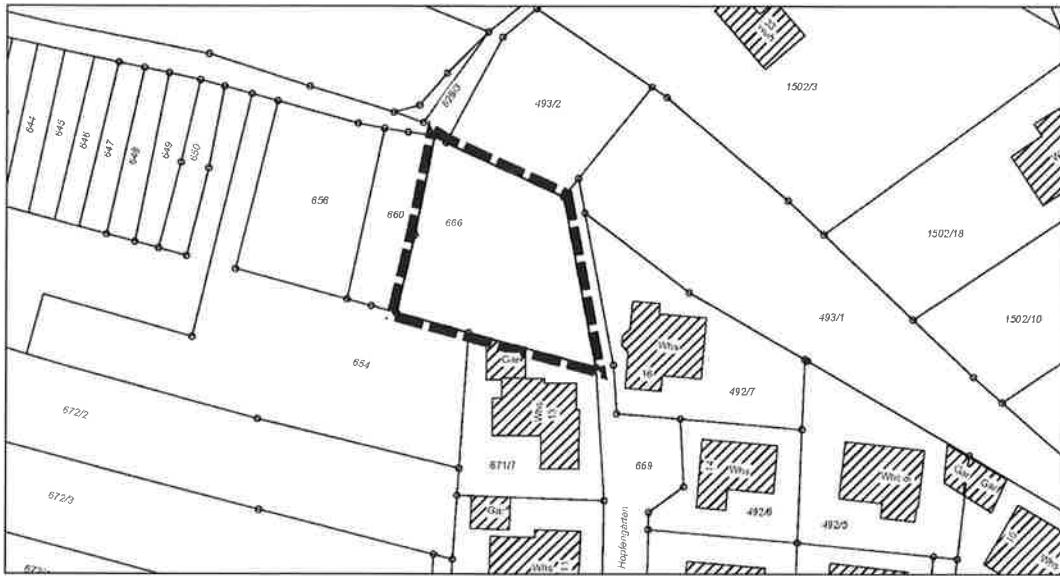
Lageplan Gebietsabgrenzung, Maßstab: M 1:1.000
